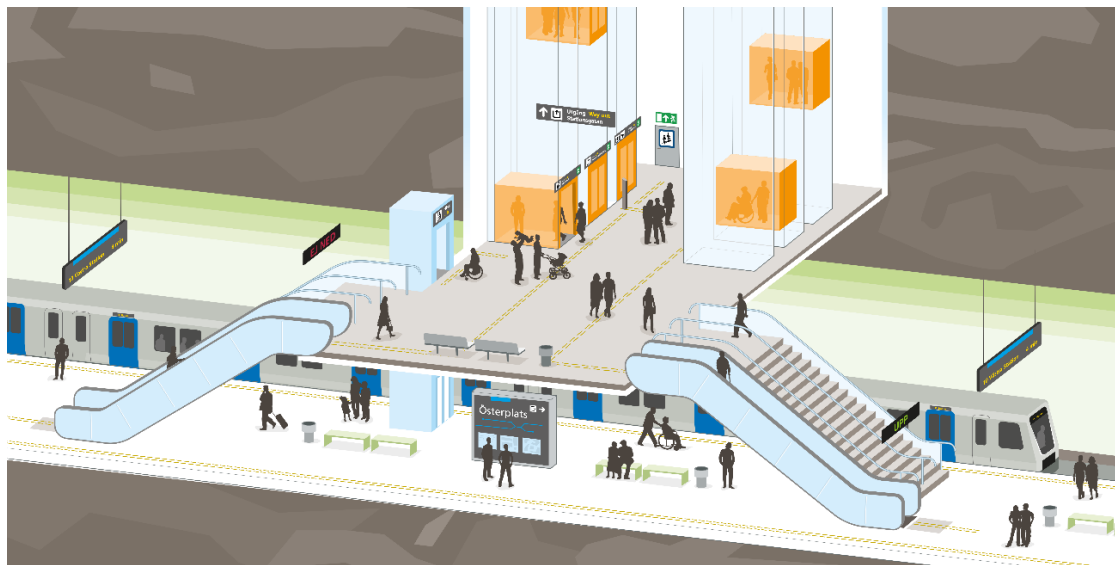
Överblick över plattformsrummet med utgång till trapphall i plattformsänden.
